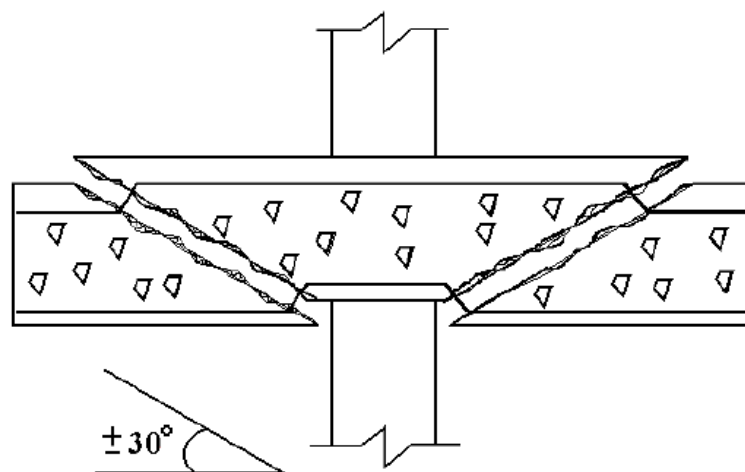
Surgimento de fissuras radiais e tangenciais em lajes lisas
